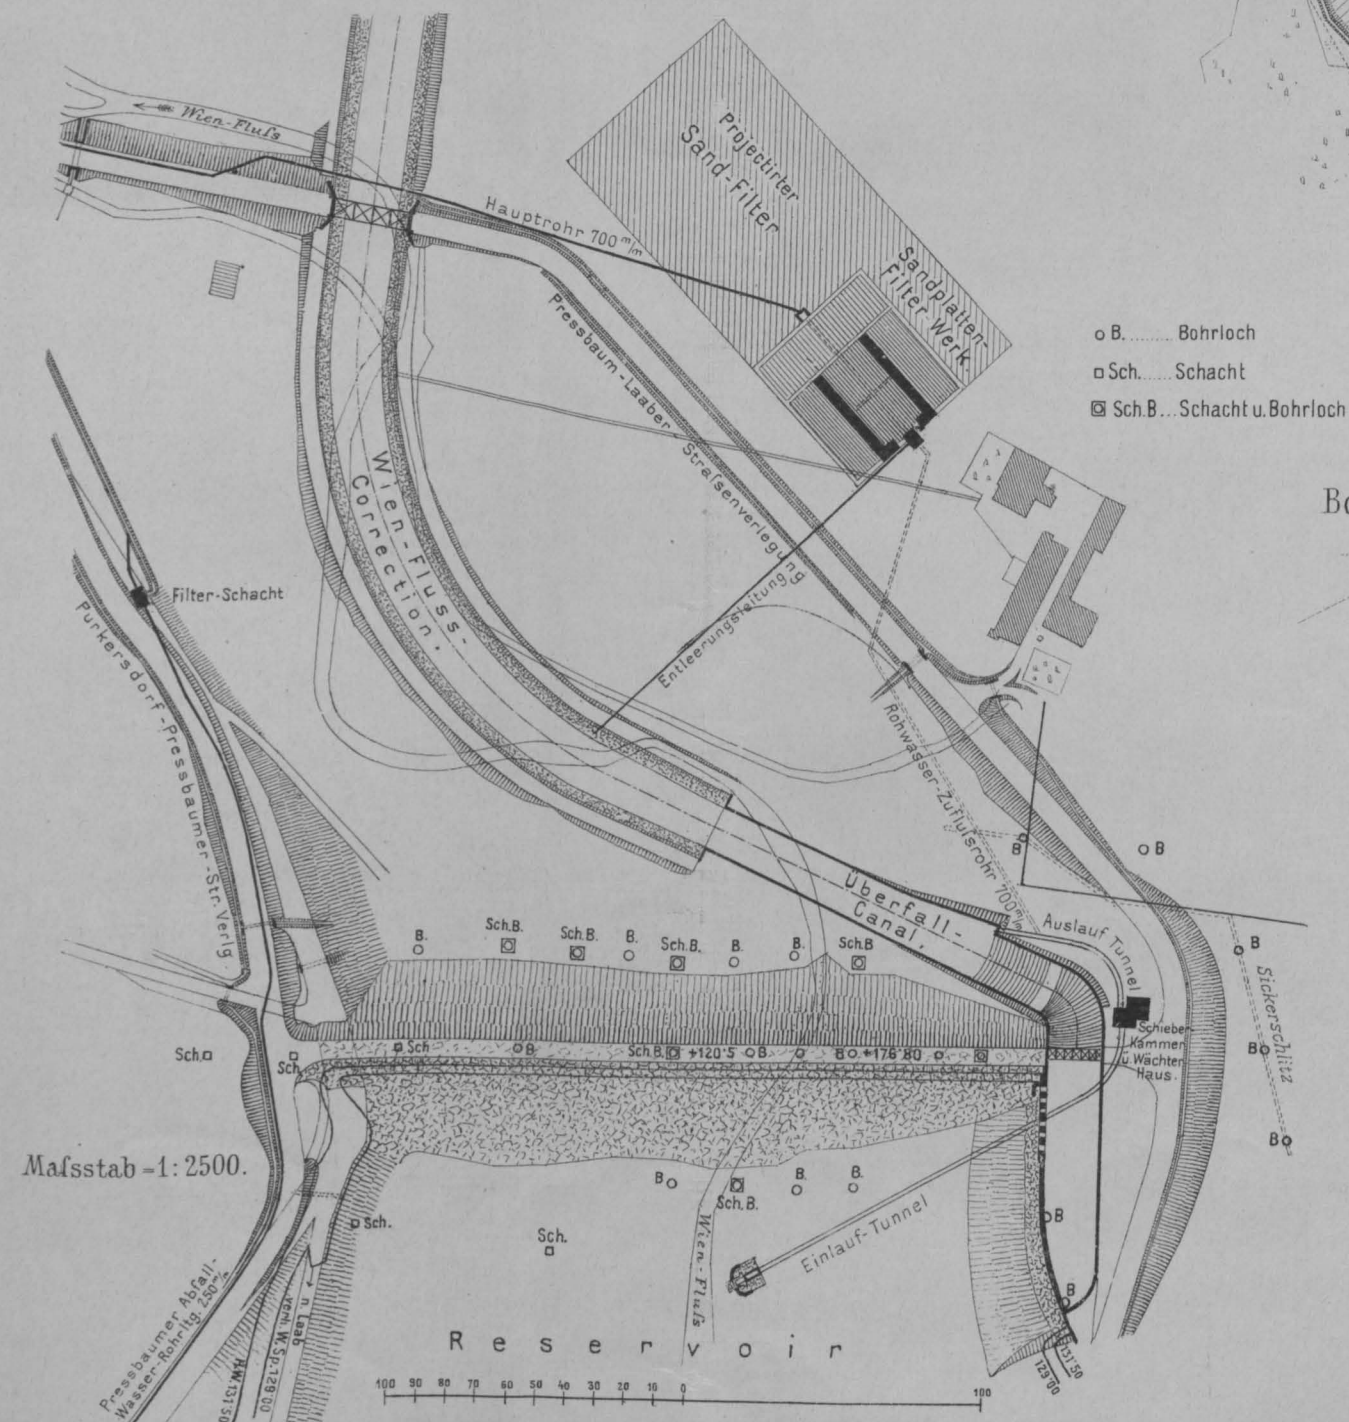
Grundriss der Sandplatten-Filter-Anlage System Fischer.
